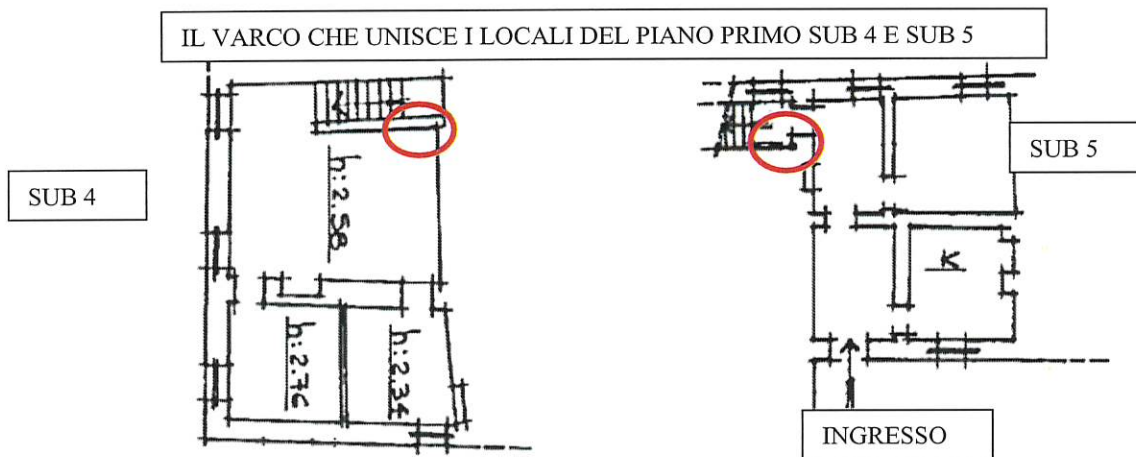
stralcio di planimetrie catastali foglio 29 mappale 125 sub 4 e 5 piano primo (allegati 1 e 2)
